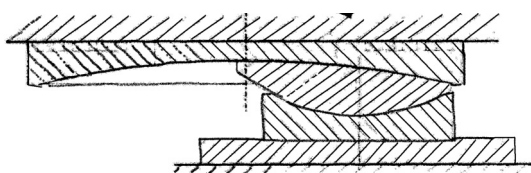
Схематичный чертеж шаровой кинематической опоры
